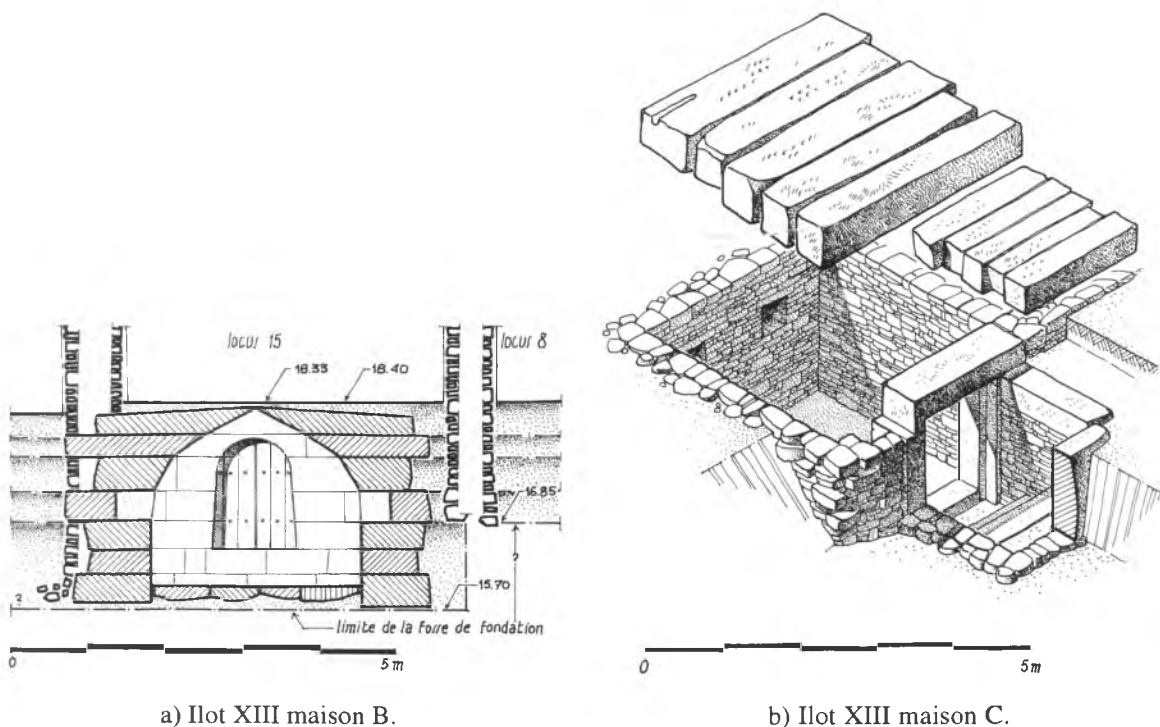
Construction de tombes au milieu des fondations (« Ville sud »).
